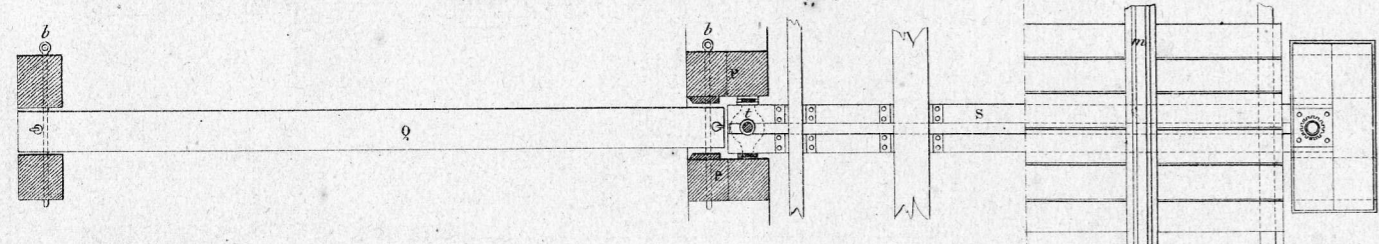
Installation de la charnière des plans inclinés de la voie de fer.
